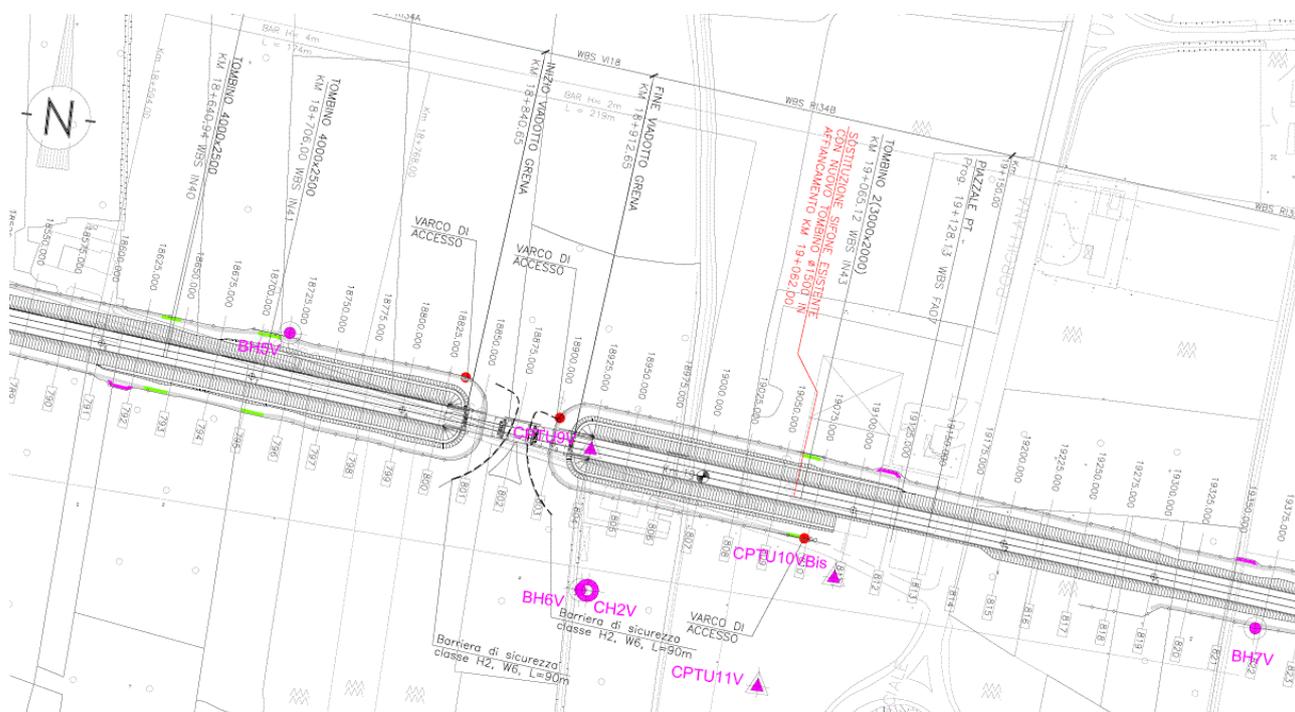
e la Figura 2 riportano rispettivamente uno stralcio della planimetria ubicazione indagini eseguite nell'area del viadotto in oggetto e la sezione geotecnica riportata nel dettaglio nel Doc.Rif.[6].
